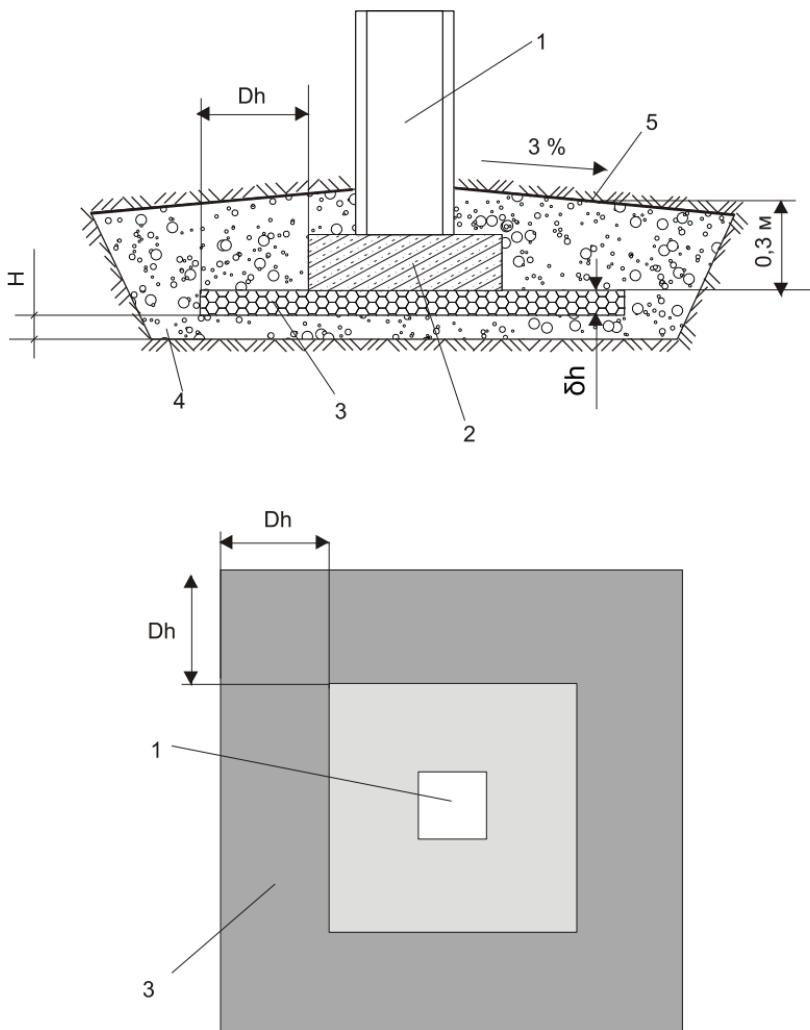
Схема укладки и параметры теплоизоляции в фундаментах отдельно стоящих опор: 1 — опора; 2 — фундамент; 3 — теплоизоляционный слой; 4 — песчано-гравийная смесь; 5 — водоупорный слой
